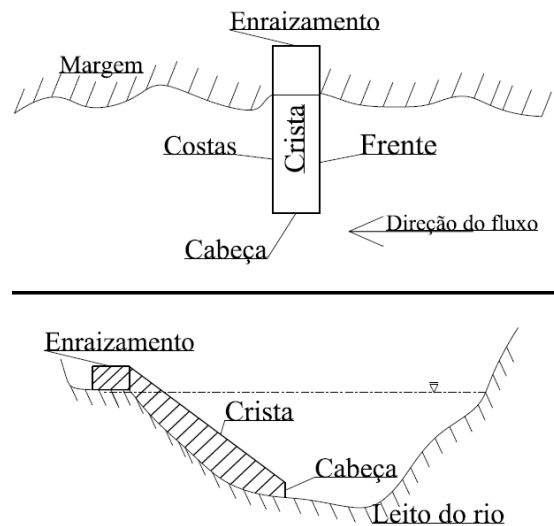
Estruturas do espigão em planta (superior) e em corte (inferior).
